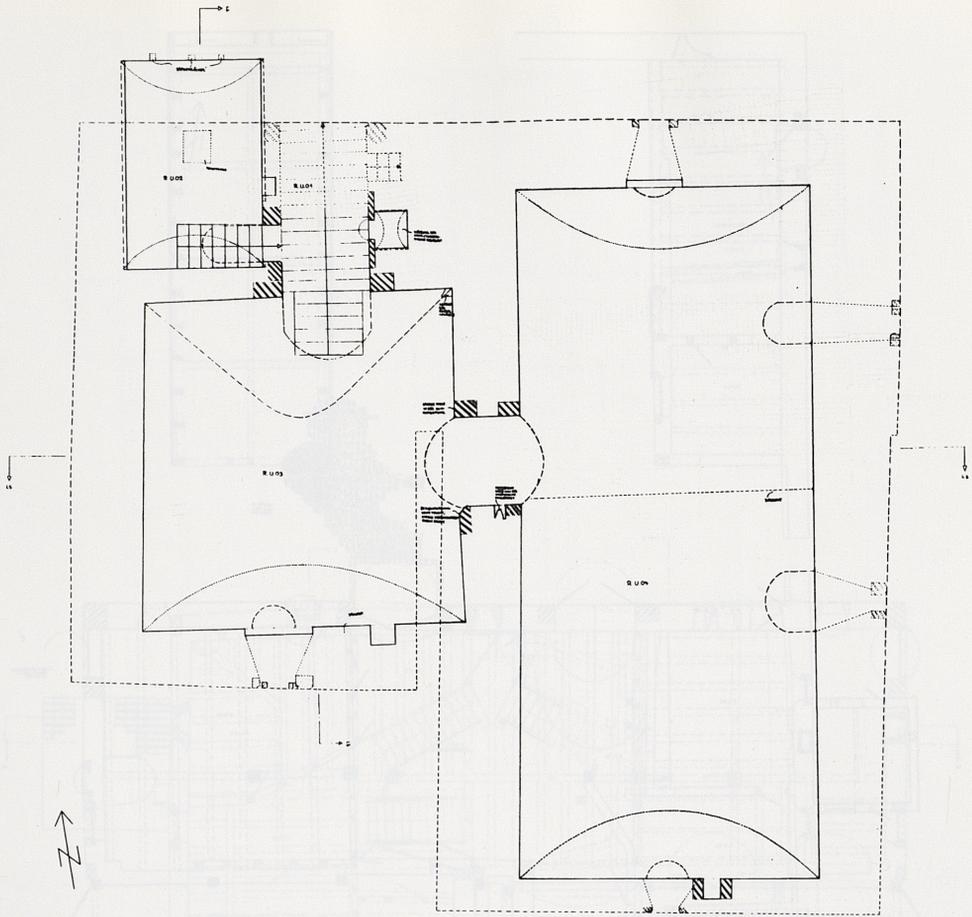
Schnait, Unteres Schloß, Silberstraße 10. Grundriß des Untergeschosses, Maßstab 1:200.
